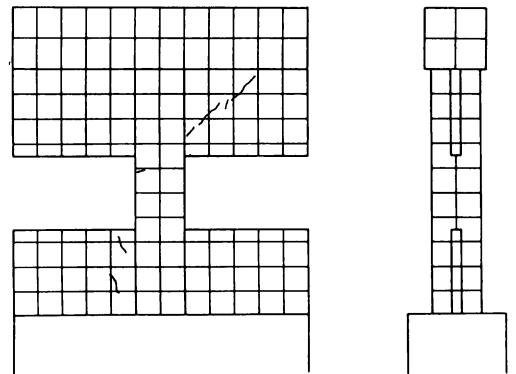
(e) 試験体 CSS05 の初ひび割れ図
